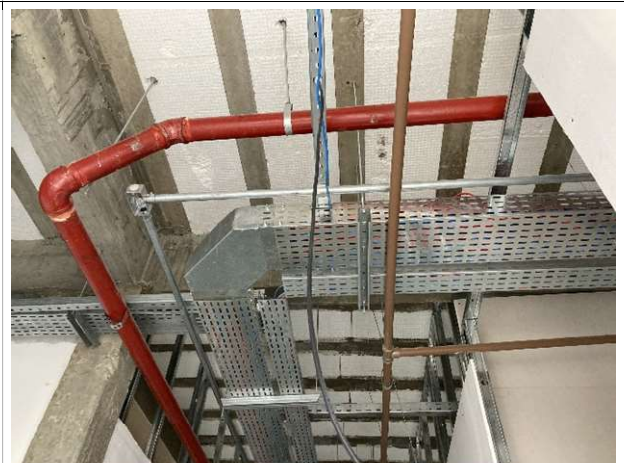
execução de instalações (incêndio, elétrica, hidráulica)
